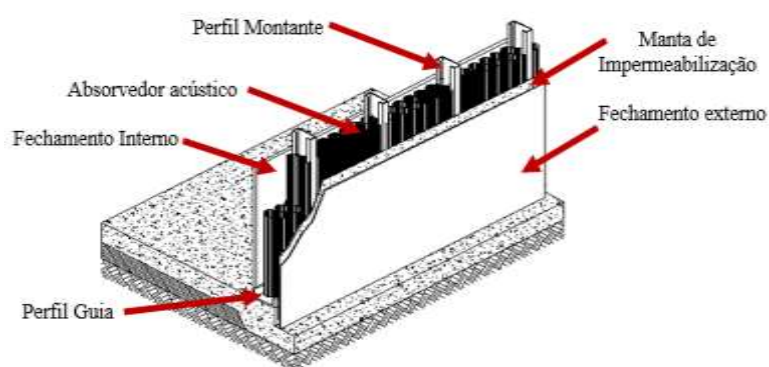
Componentes utilizados em uma parede típica em *Light Steel Framing*.
